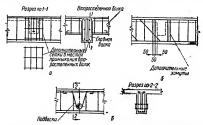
88. Дополнительная арматура, устанавливаемая в балках:
